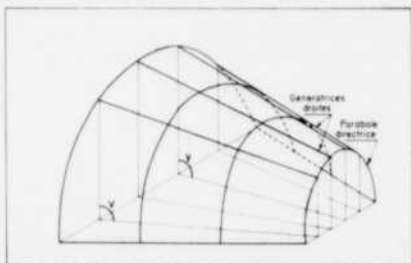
Vue en perspective d'un voile engendré par des génératrices rectilignes.
